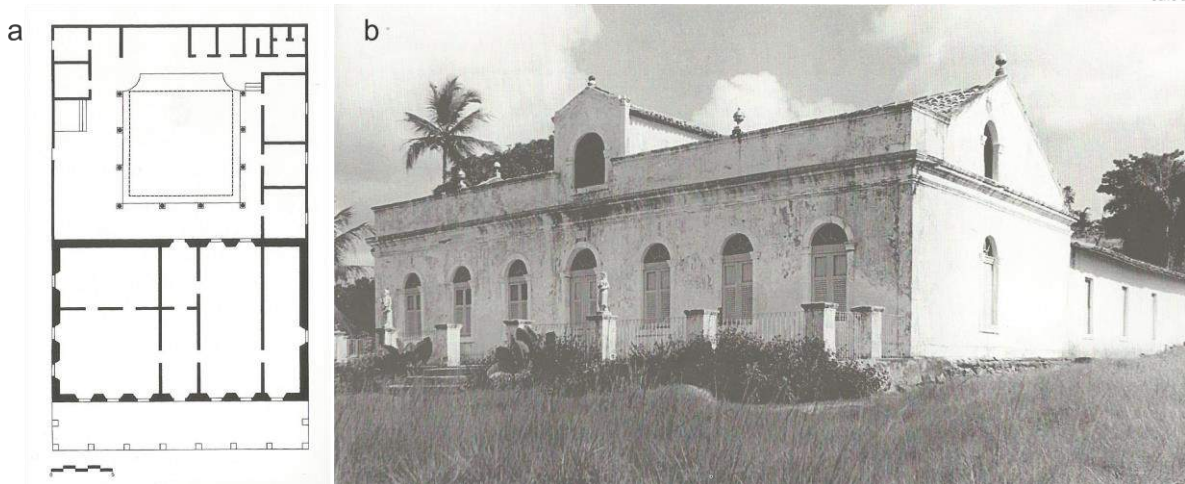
Casa-grande do engenho Massangana. a –planta baixa; b – vista da fachada principal.
